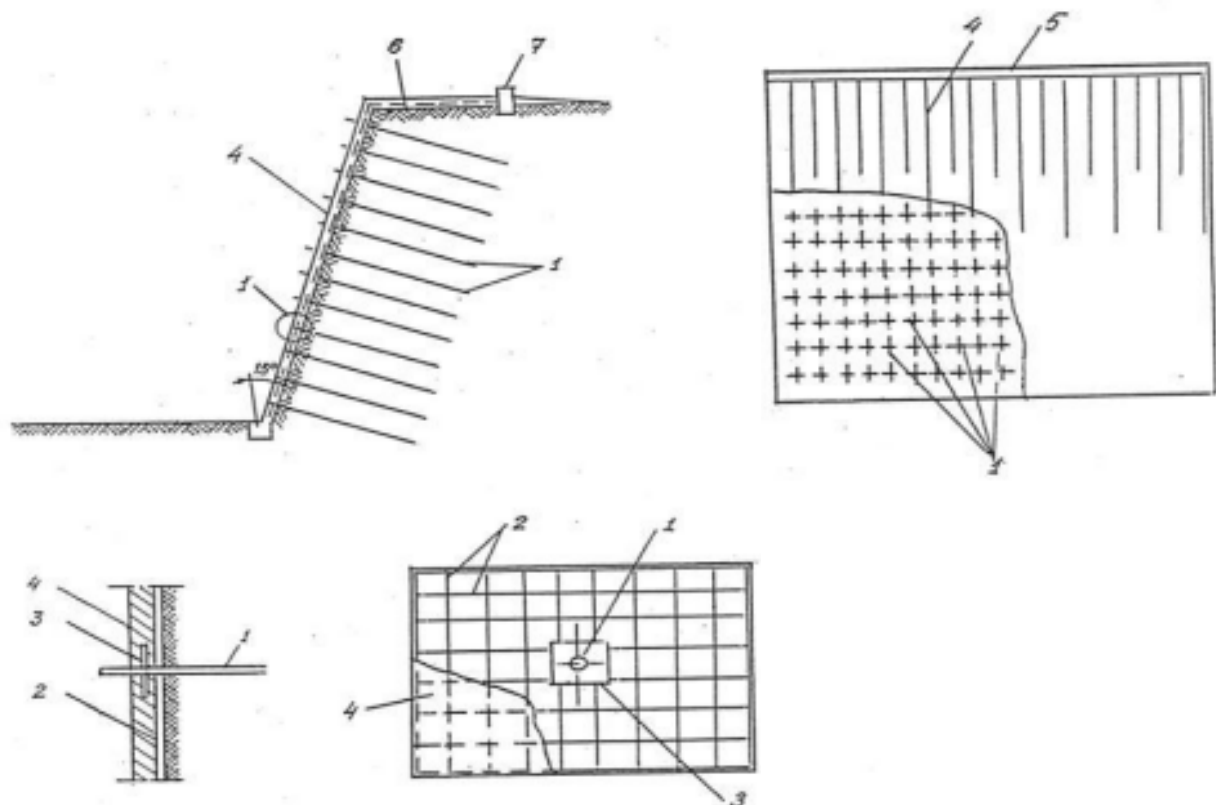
Типовая конструкция нагельного крепления с защитой поверхности откоса котлована набрызг-бетоном: 1 – армирующие стержни; 2 – сетка; 3 – упорная пластина; 4 – слой набрызг-бетона; 5 – слой бетона; 6 – слой щебня, втрамбованного в землю; 7 – бетонный бортик
